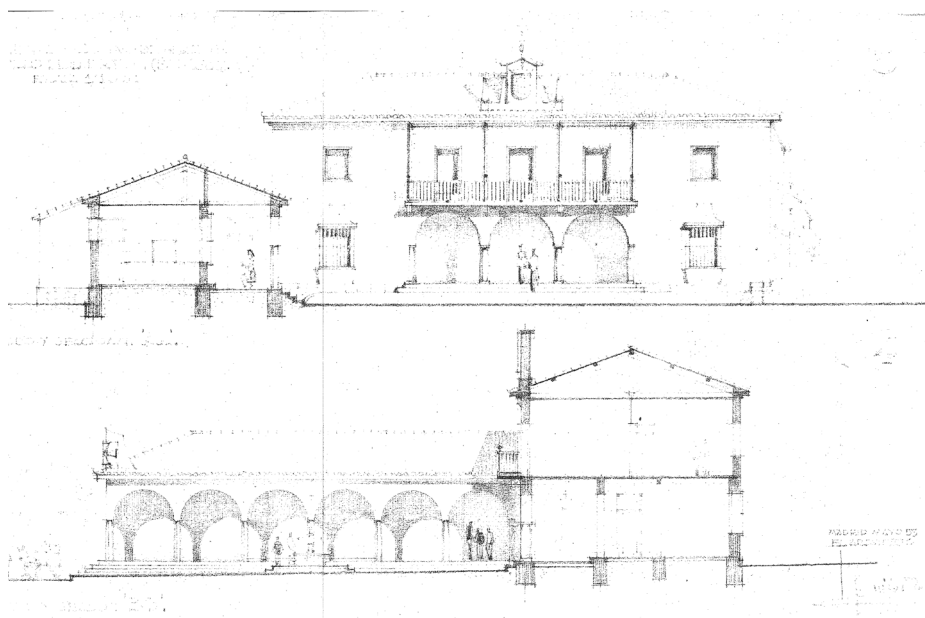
Plano de “Reconstrucción y Reforma”. Alzados.
